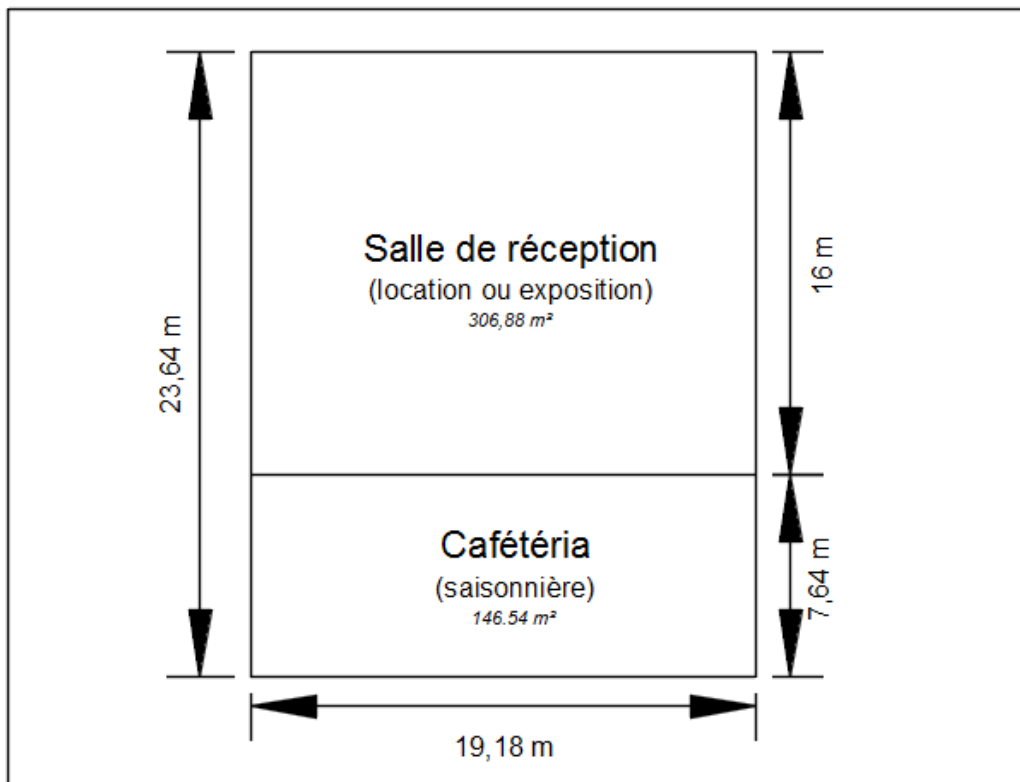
Modélisation AutoCAD du plan proposé du plus grand bâtiment
